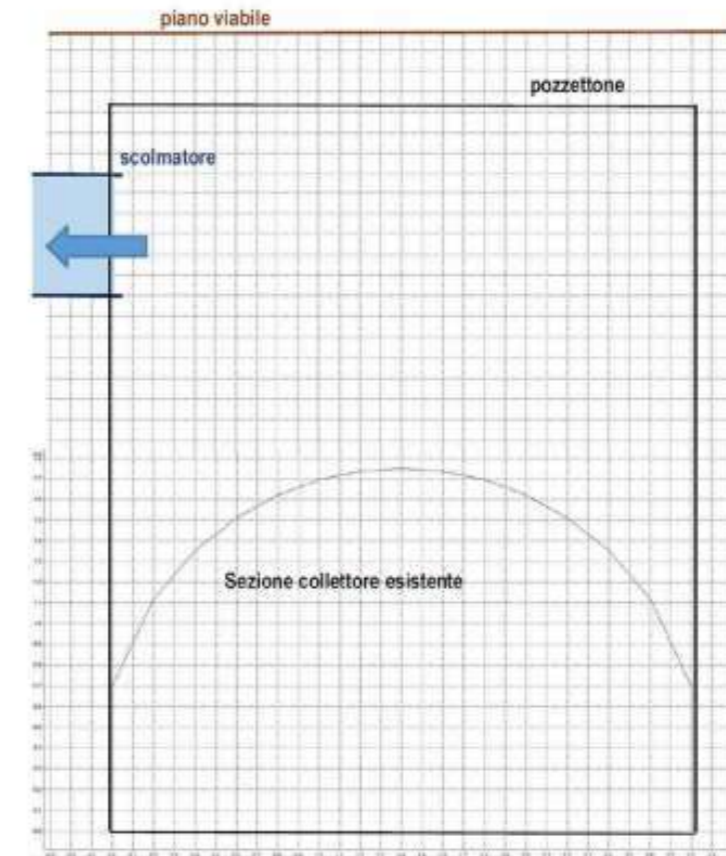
Schema di progetto del manufatto di alimentazione della vasca di laminazione.
